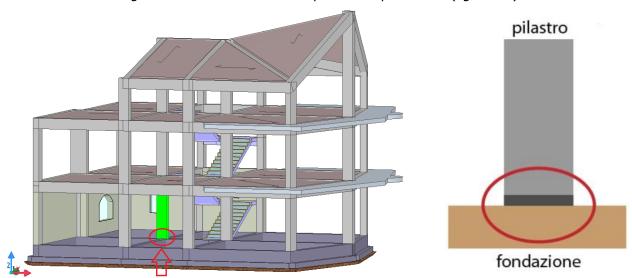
Vista 3D - pilastro oggetto di verifica
